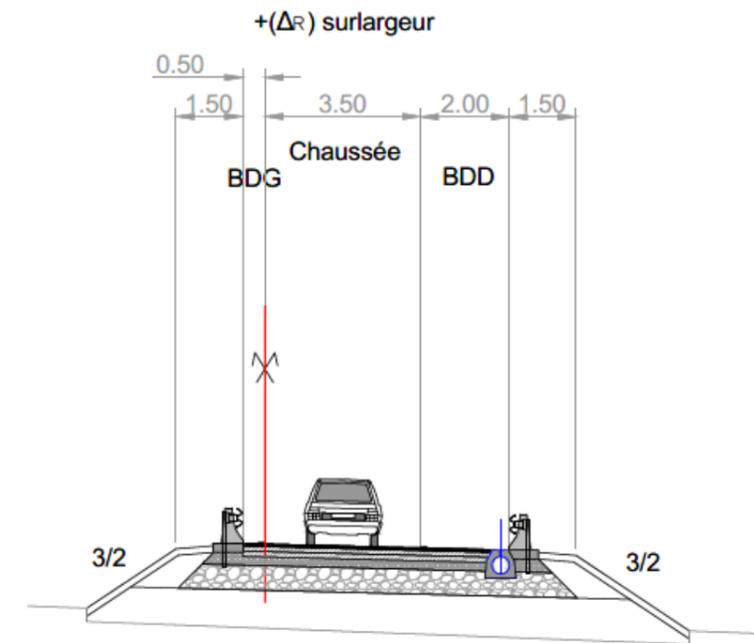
Profil en travers type d'une bretelle unidirectionnelle (bretelles des échangeurs M6d et M952)
